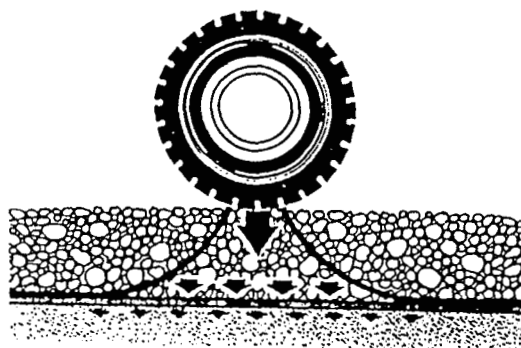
Construcción de una pista de transporte con lámina filtrante.
